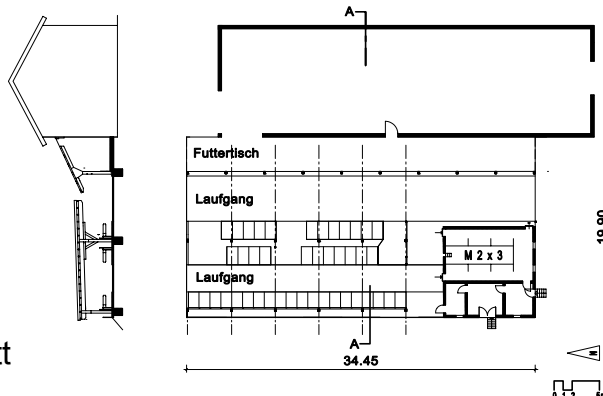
Ansicht, Grundriss – Schnitt
